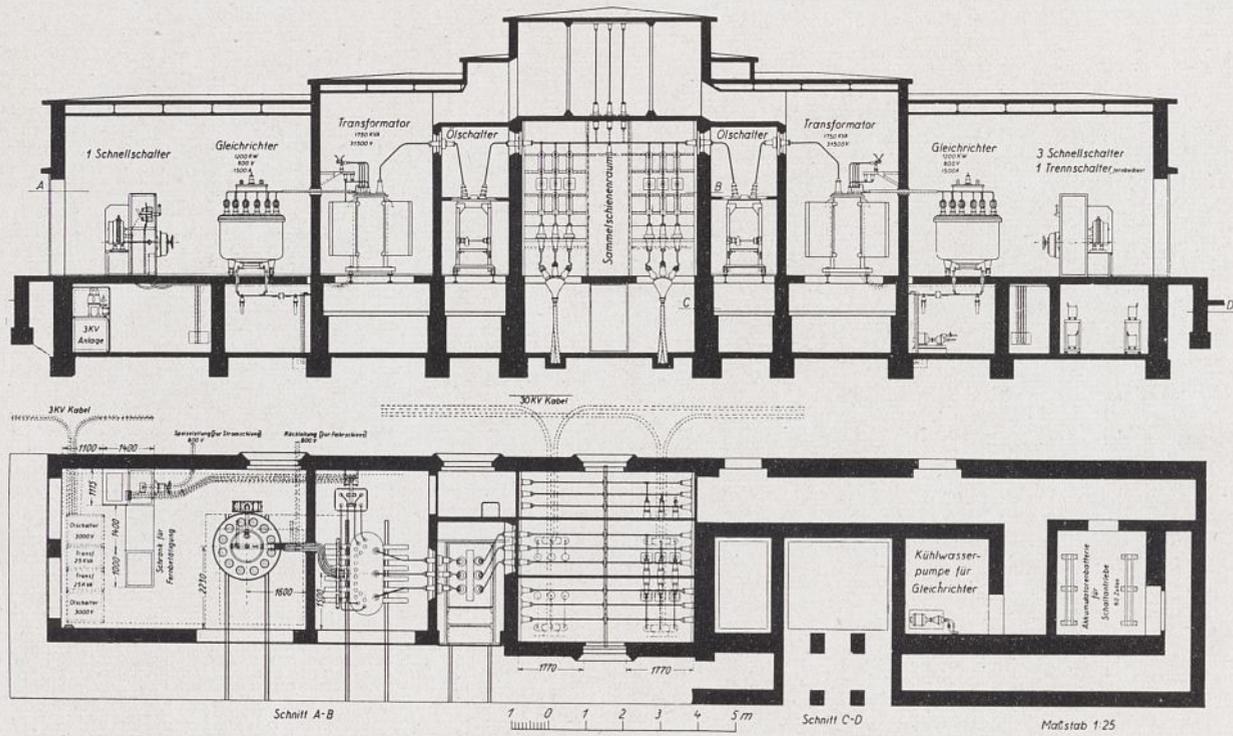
und 21. Kleingleichrichterwerk in Regelbauart. Grundriß und Längsschnitt. M. 1:200.
